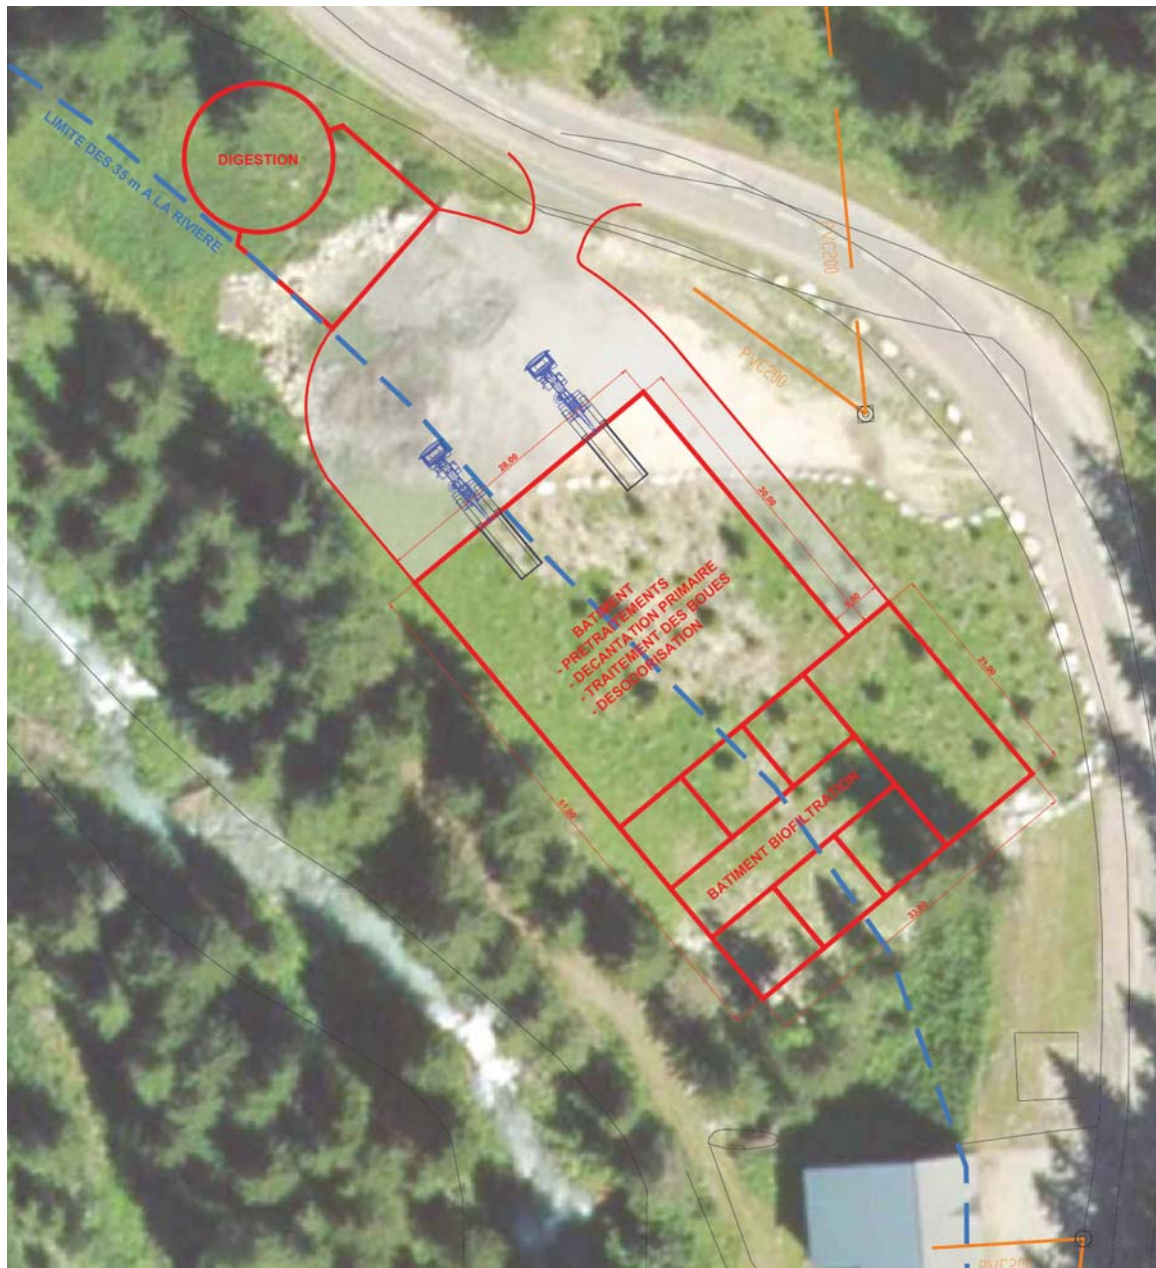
Extrait du plan PLN004– Implantation sur le site de la décharge
